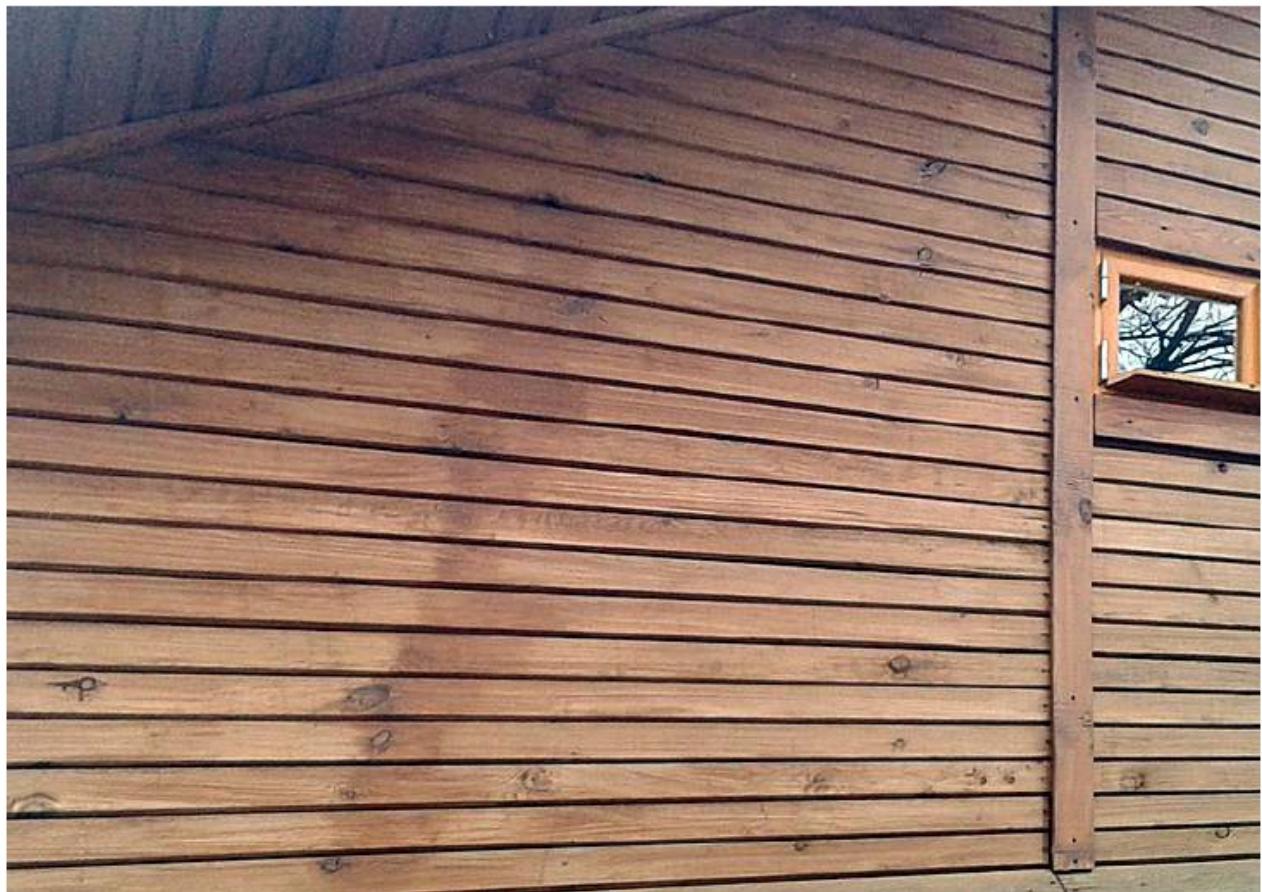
Нанесение антисептика на фасад дома с перерывами.
